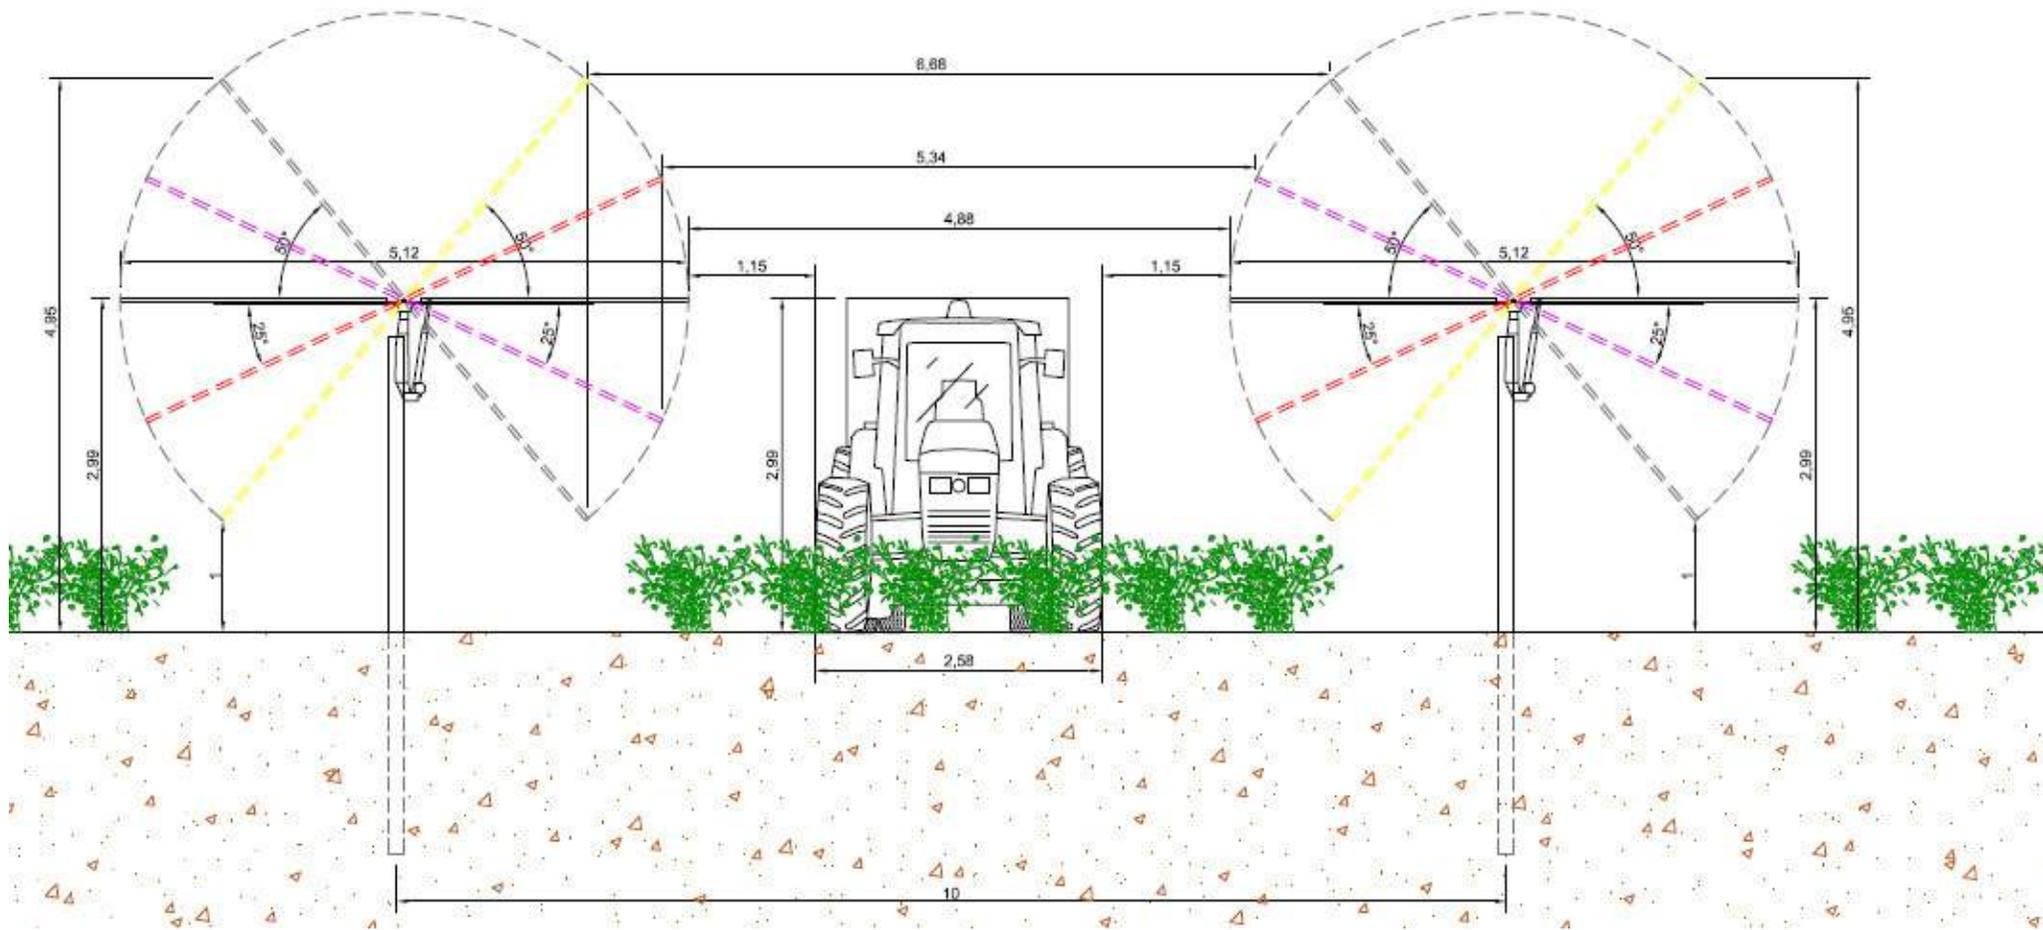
Schema di impianto in sezione trasversale con trackers in posizione orizzontale
